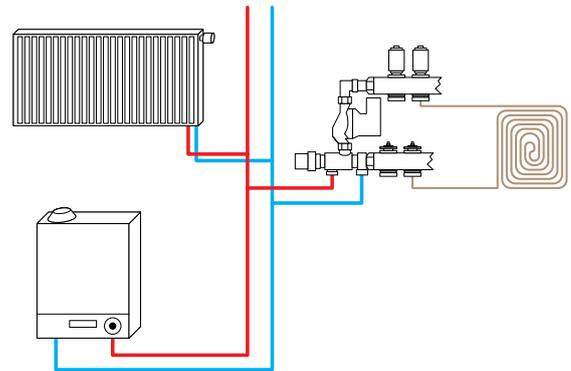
Anschlusschema mit primärer Umwälzpumpe im Wärmeerzeuger
